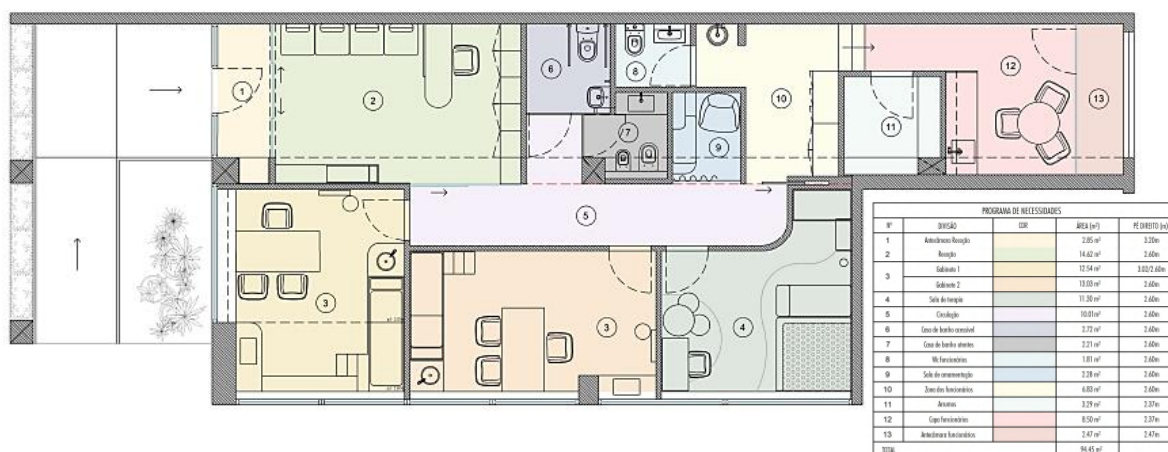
Planta final de layout - Projeto CNP. Fonte: Equipa FBN.
